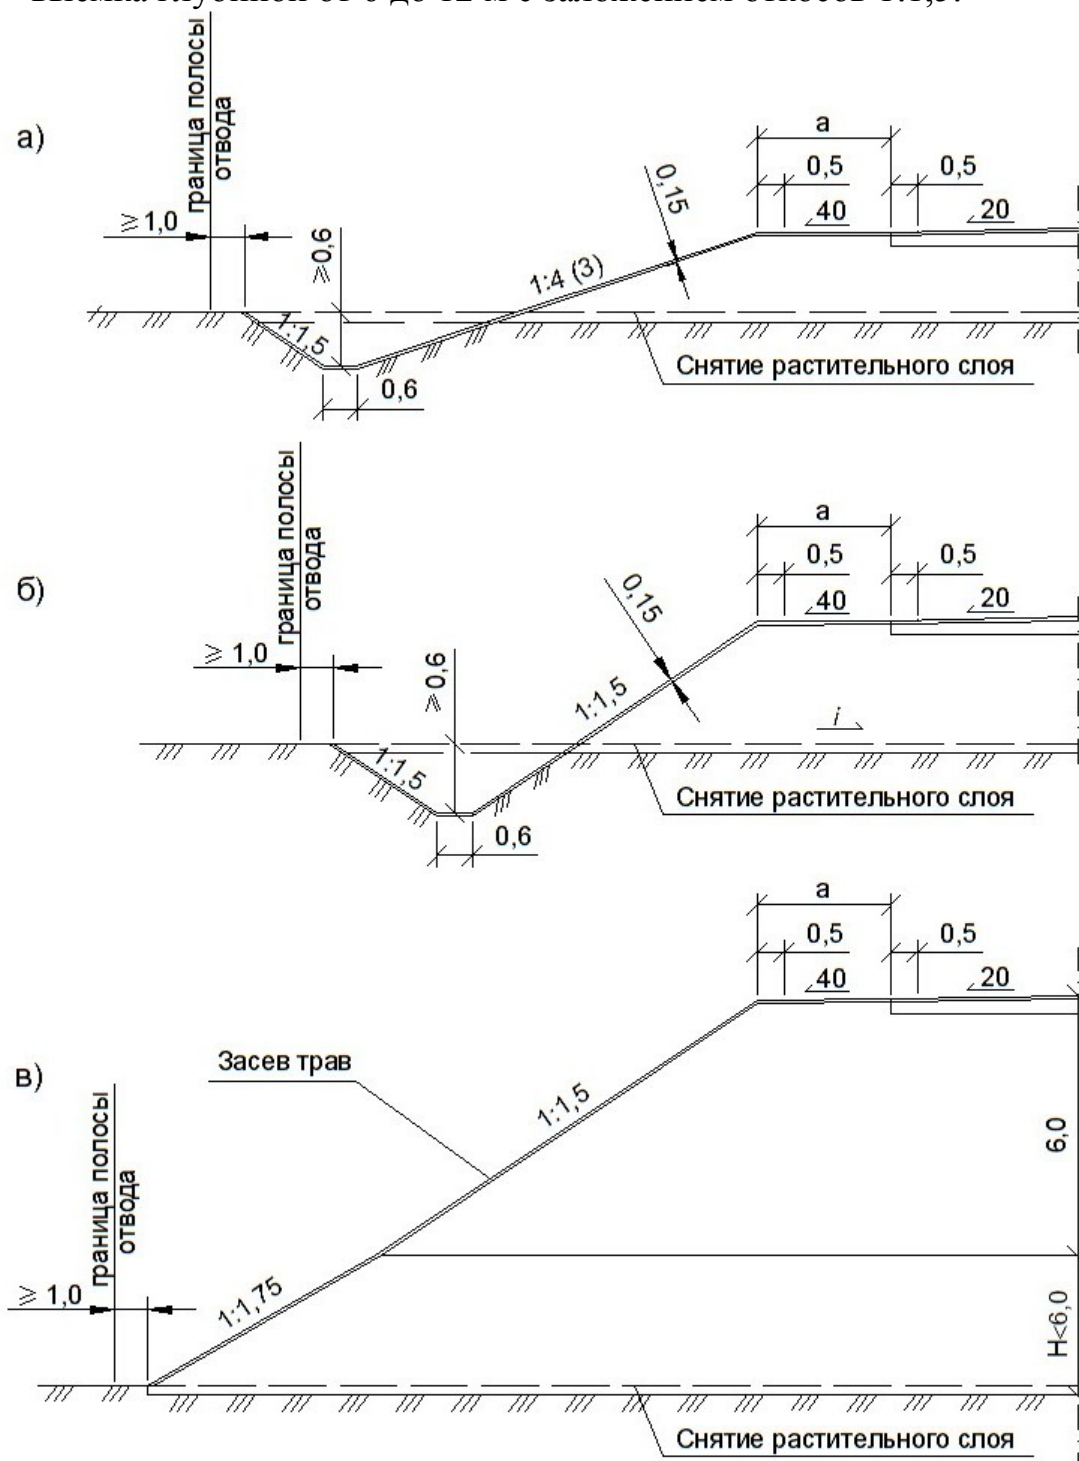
Принципиальные схемы поперечных профилей насыпей: а) насыпь высотой до 1,5 м с двумя канавами; б) с канавой; в) насыпь высотой от 3 до 6 м с равнопрочными откосами.
